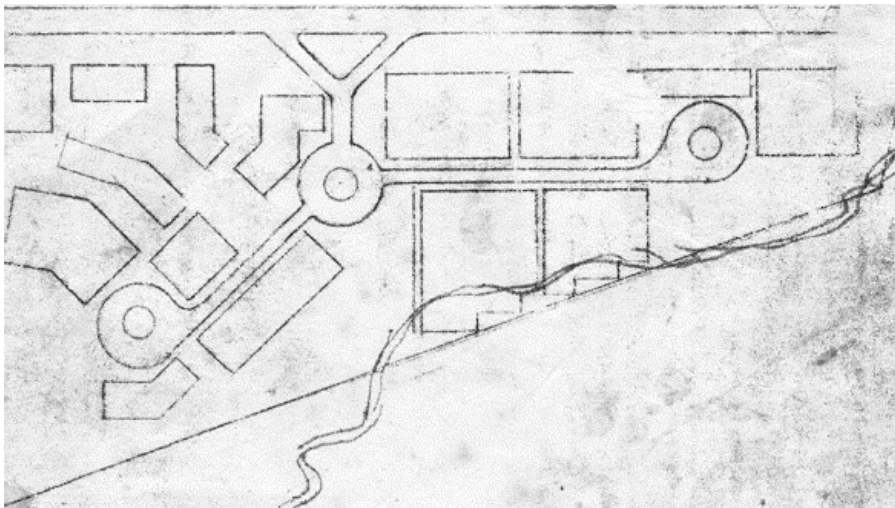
Zonificación primer cementerio de orden privado en Sincelejo.
